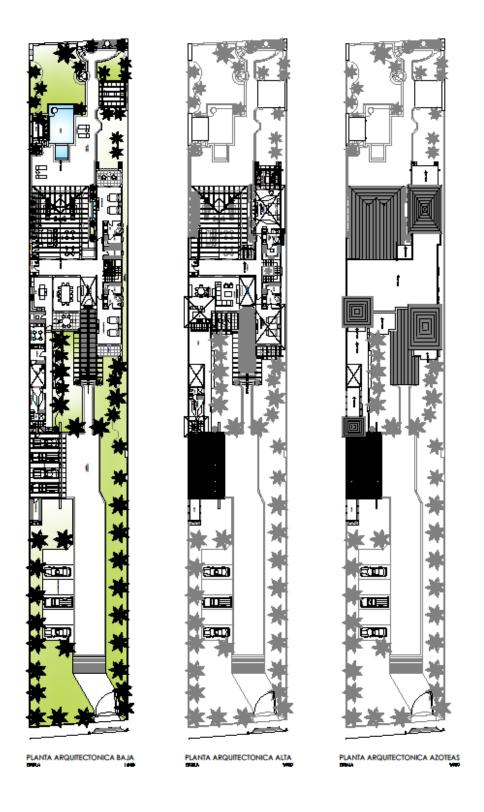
Planos arquitectónicos delas diferentes plantas del proyecto.
